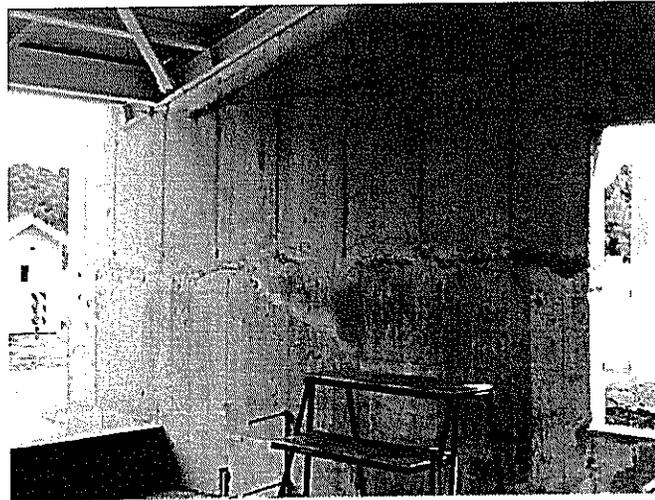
Encuentro muro-pilar del eje 8.
